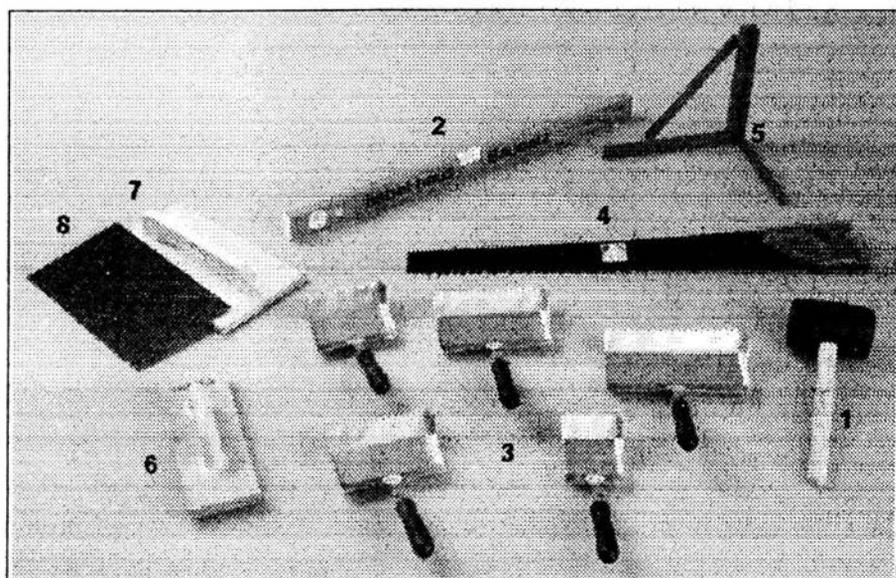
En la figura se ilustran las herramientas manuales que se usan en la construcción con concreto celular para efectuar adecuadamente las tareas de corte y ajustes en construcción de muros de bloque de concreto celular.
